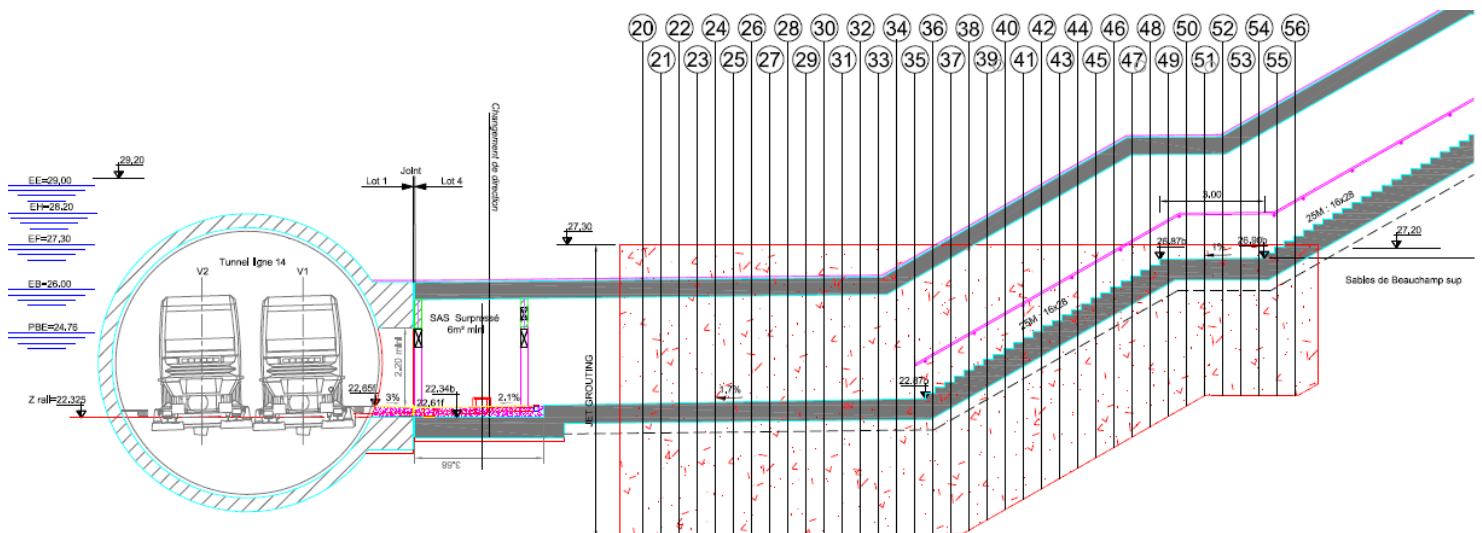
Extrait du plan d'exécution: coupe longitudinale à l'axe de la galerie.
